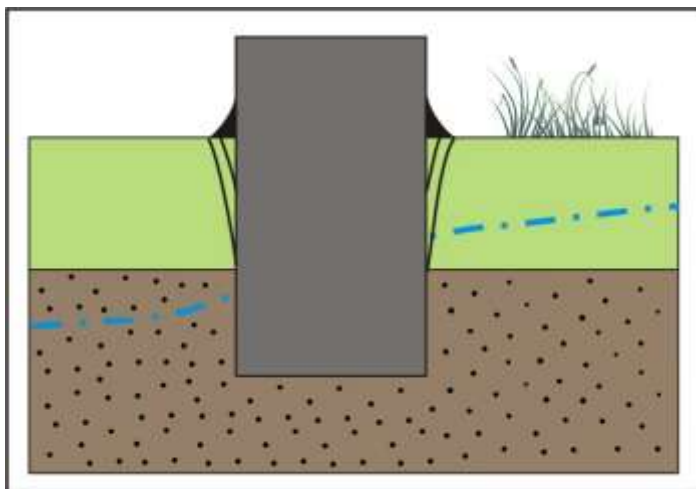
Принципиальная схема формирования барражного эффекта и подтопления территории при перекрытии фундаментом части грунтового потока
